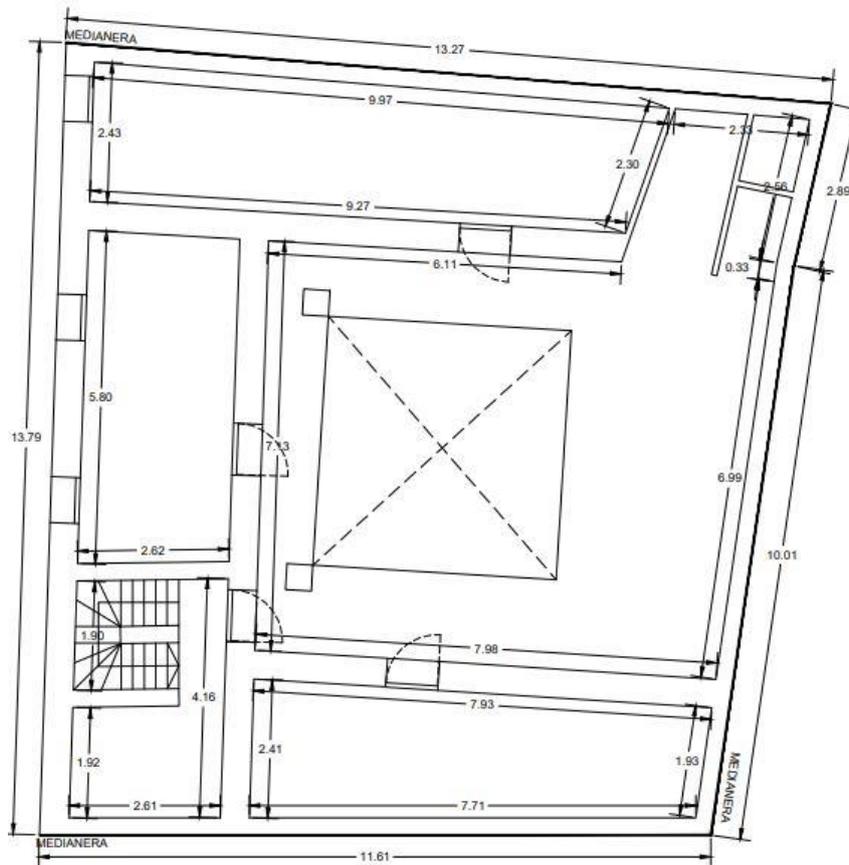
Plano planta segunda del edificio (Elaboración propia)
